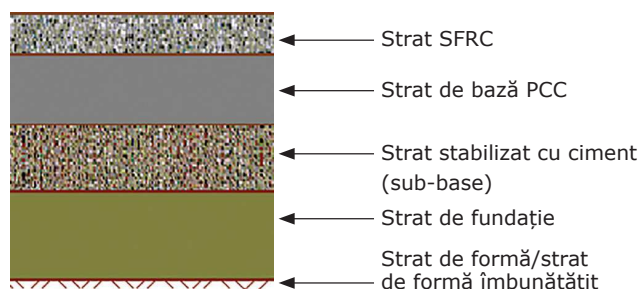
Opțiunea B1 – Dală din beton armat cu fibre din oțel (SFRC) așternută pe un strat de bază din PCC și un strat de sub-bază stabilizat cu ciment sau cu rezistențe scăzute
